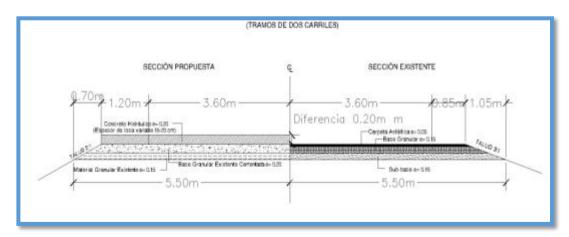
Sección Típica de Alternativa Pavimentación Con Concreto Hidráulico
